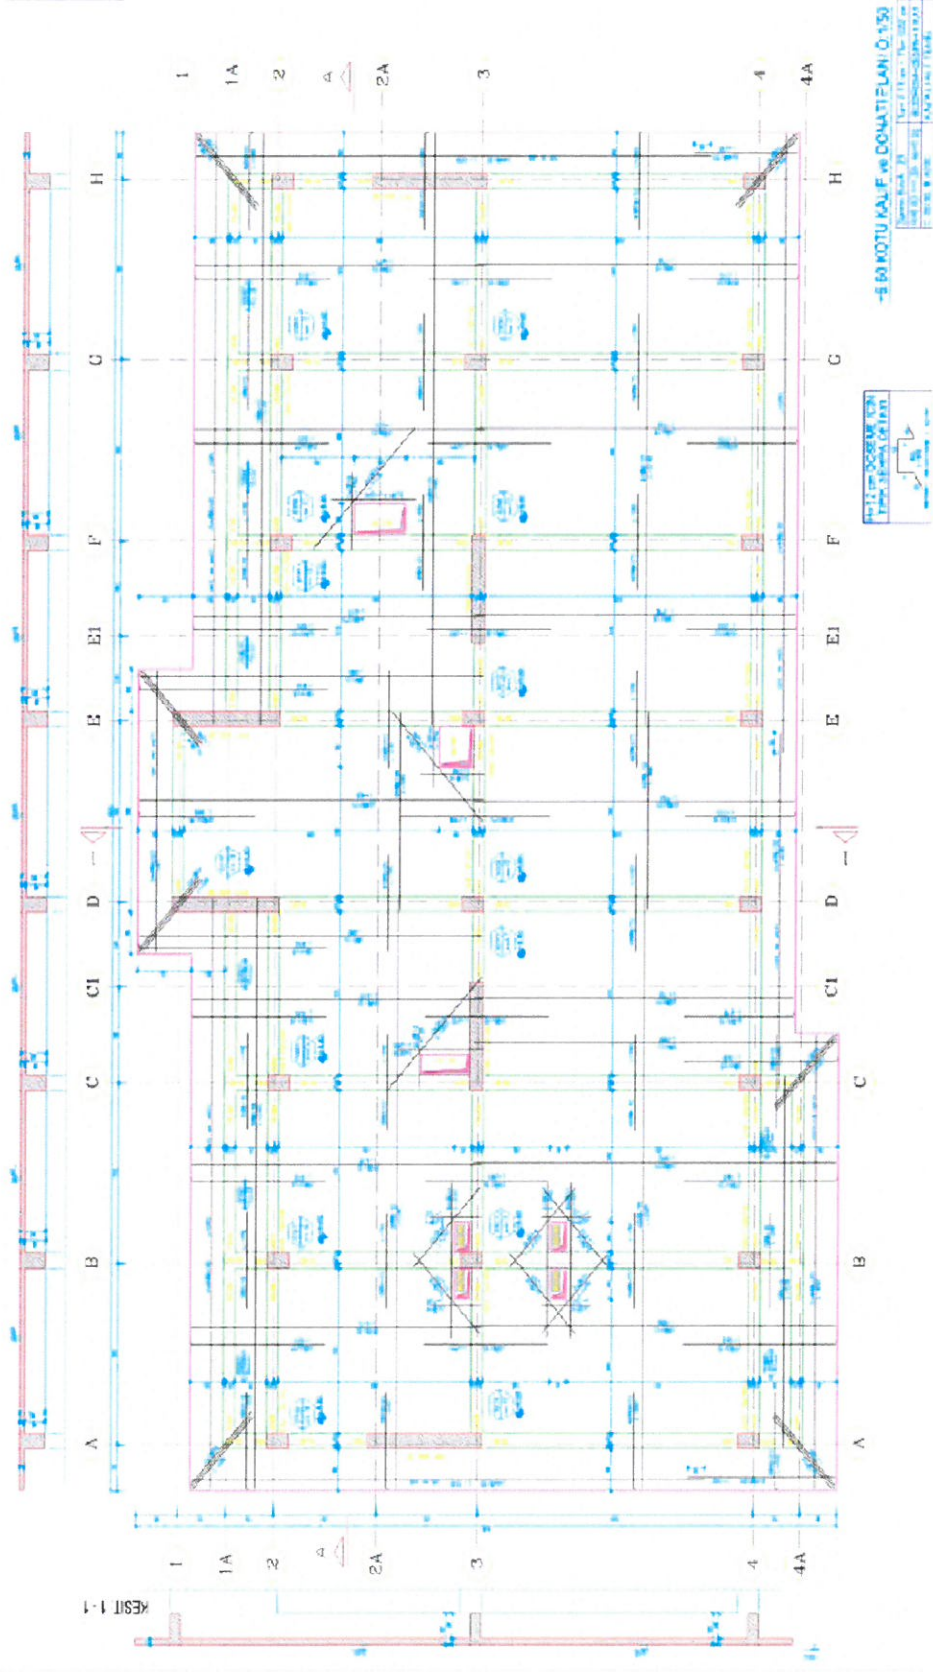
Trafik tesisler binası statik proje bodrum ile zemin kotları arası kolon aplikasyon planı
